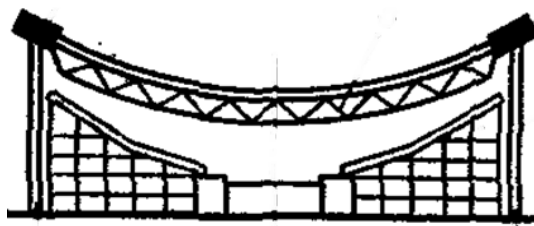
Разрез здания, образованного вантовыми конструкциями с жесткими вантами
